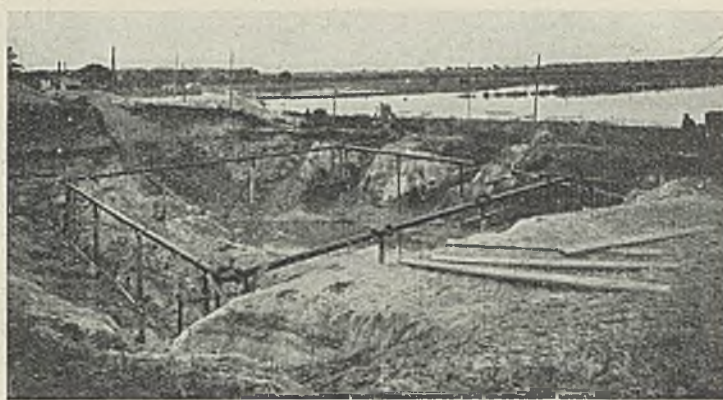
Baugrube etwa 7 m tief ausgeschachtet bei 5,40 m Grundwassersenkung.
